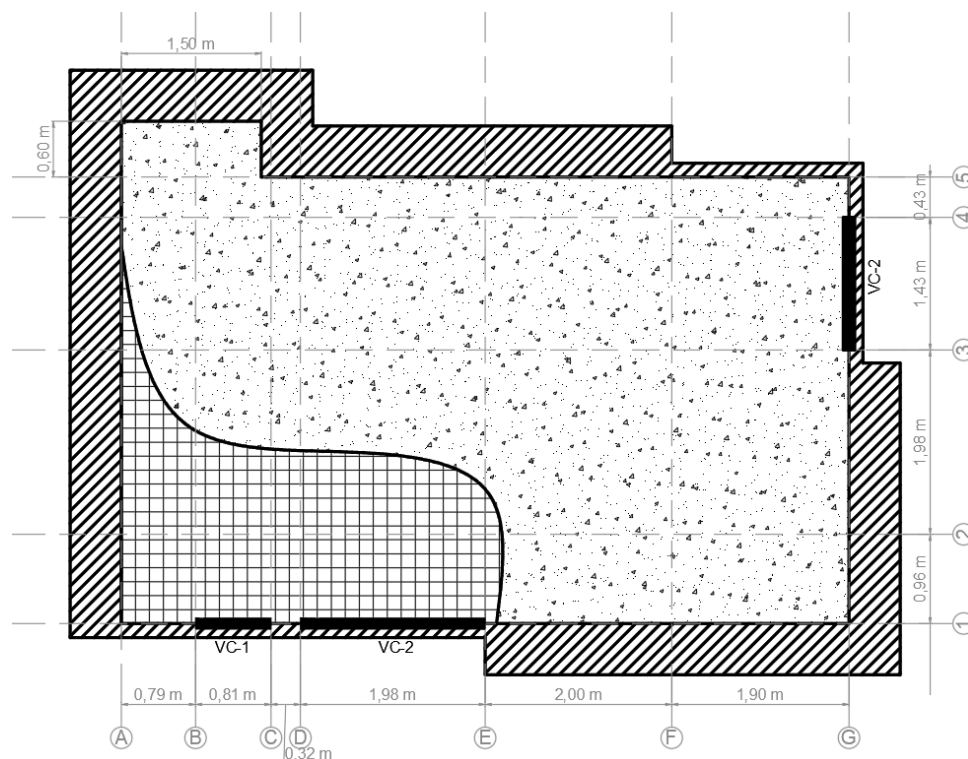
Vista en planta de losa vista en campo con restricciones a los lados
